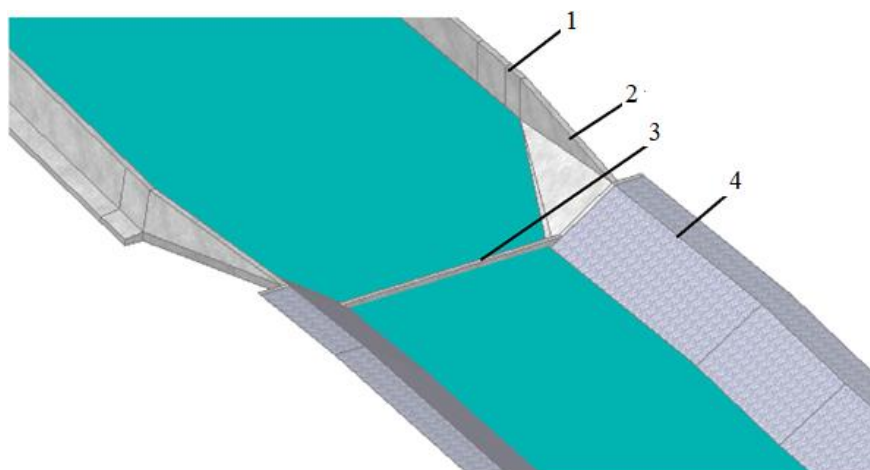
Схема размещения регуляционных сооружений на участке сопряжения: 1 – вертикальные подпорные стенки; 2 – участок сопряжения по типу ныряющей стенки; 3 – донная поперечная стенка; 4 – крепление грунтовых струенаправляющих дамб рваным камнем
